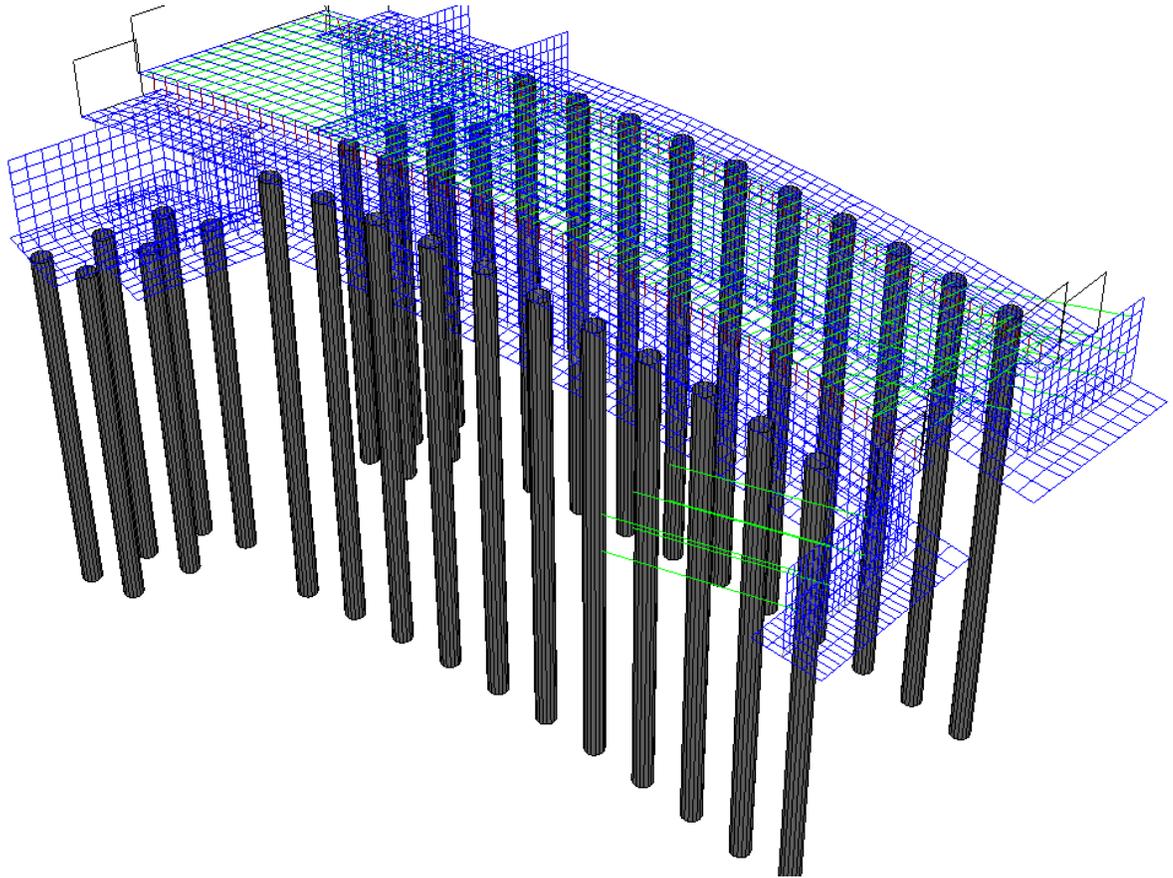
Modello 3D - Particolare dei pali di fondazione
